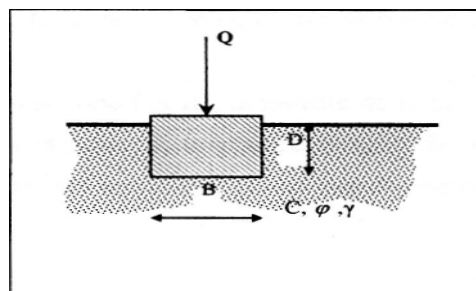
Semelle reposant sur un sol (c,φ)
